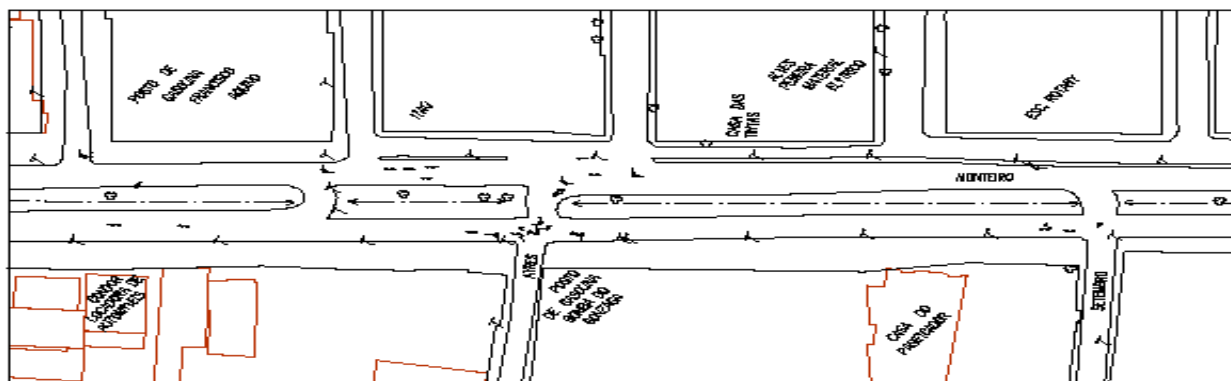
planta baixa do projeto – trecho Bomba da Marieta - Colisões
